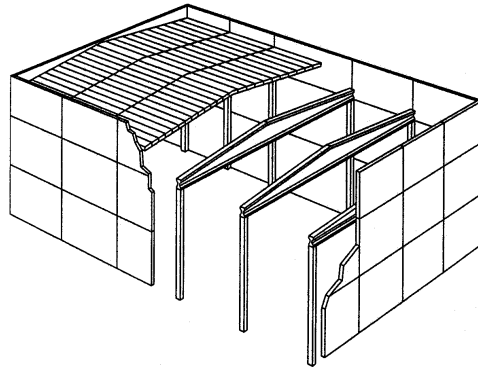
Portiekconstructie met dak- en wandbekleding.
